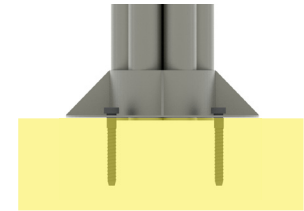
Puntos de soldadura del sistema.
